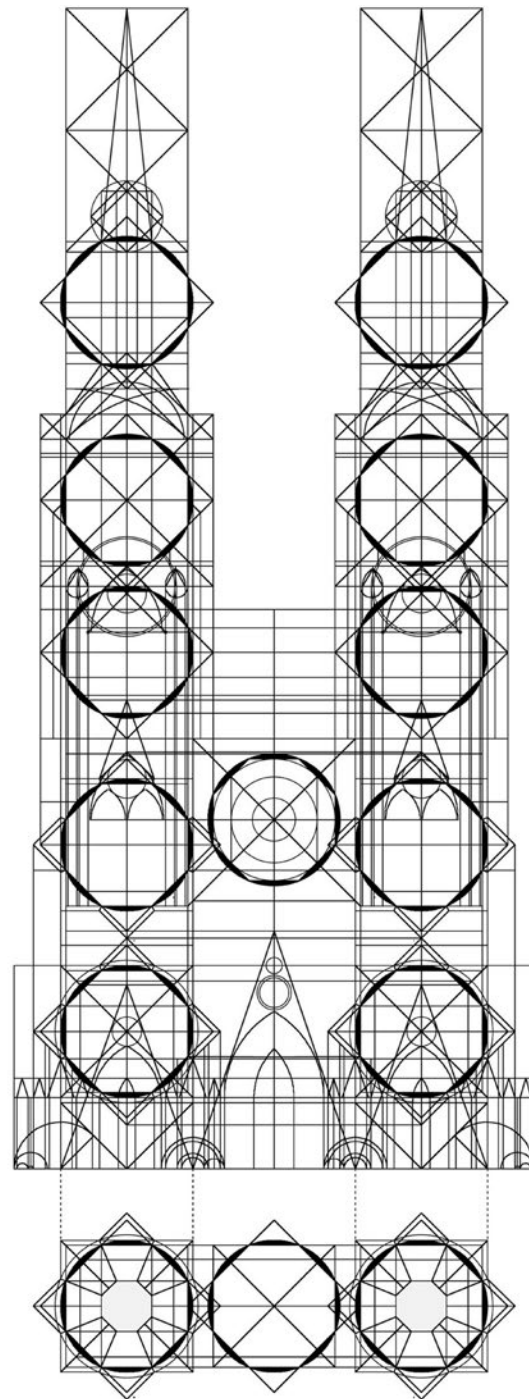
Strasbourg, dessin B, armatures géométriques dans les plans vertical et horizontal.
